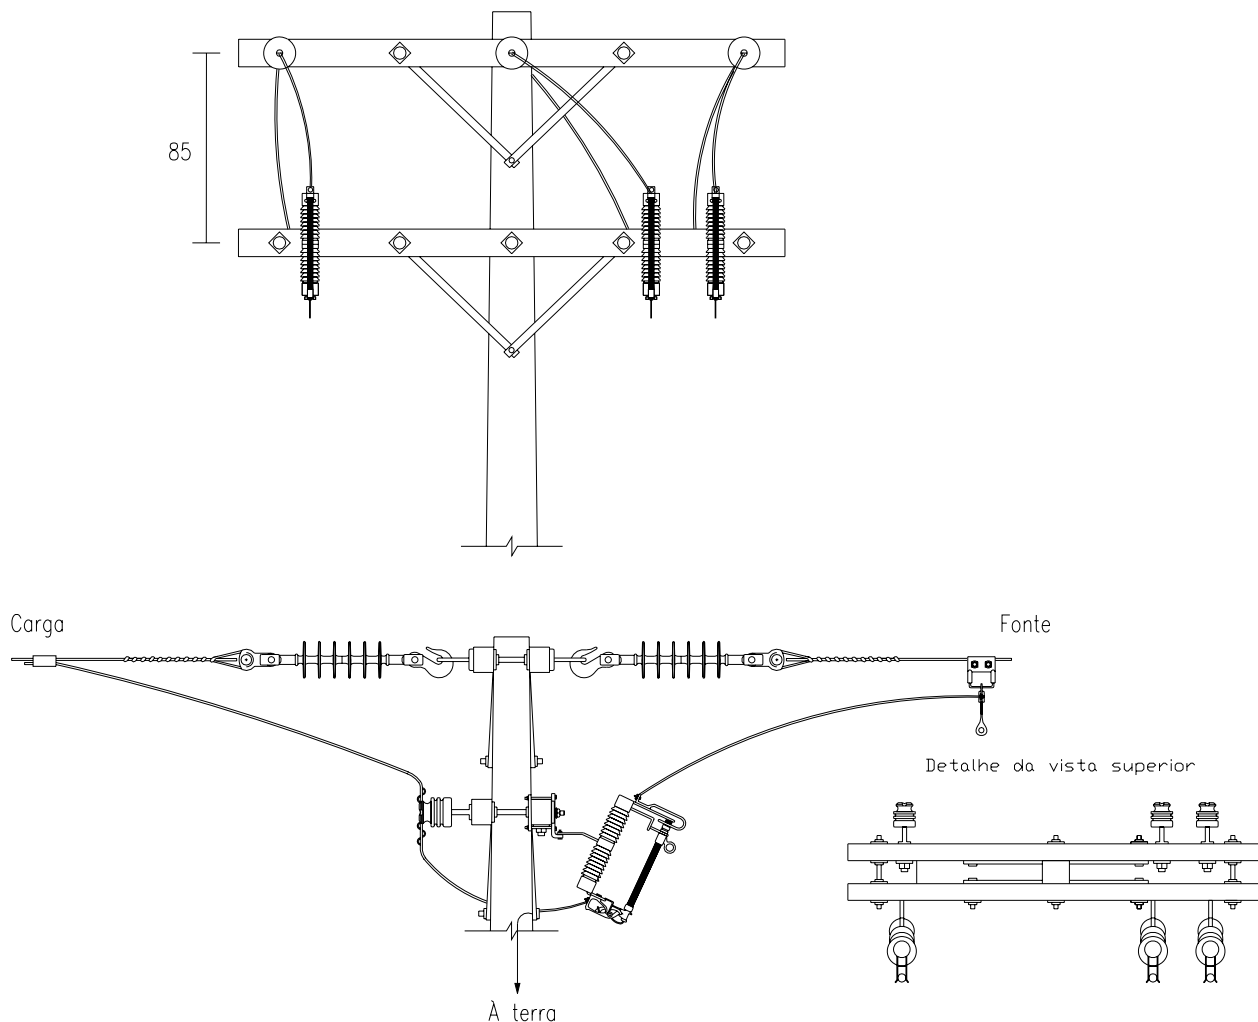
Estrutura N4 chave Fusível (proteção) (montagem alternativa)
